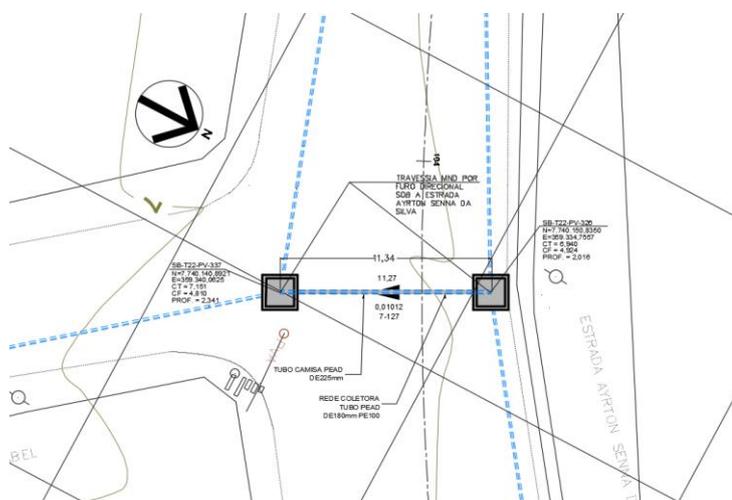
Planta de localização da travessia SB-T22 PV-326 AO PV-337
